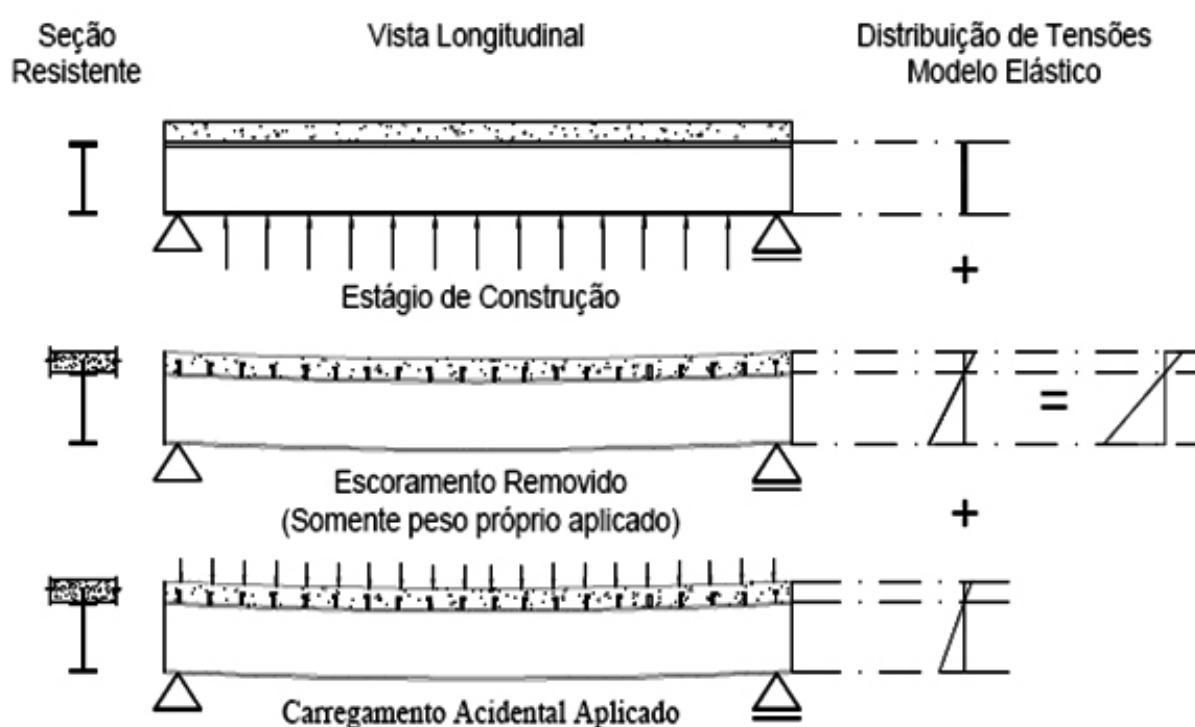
VIGAS MISTAS ESCORADAS
